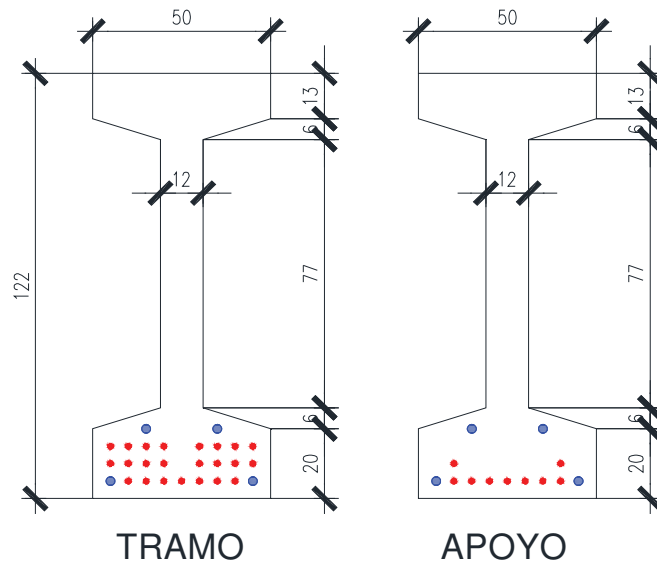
Sección Viga Prefabricada Pretensada en Tramo y en Apoyos Extremos.
